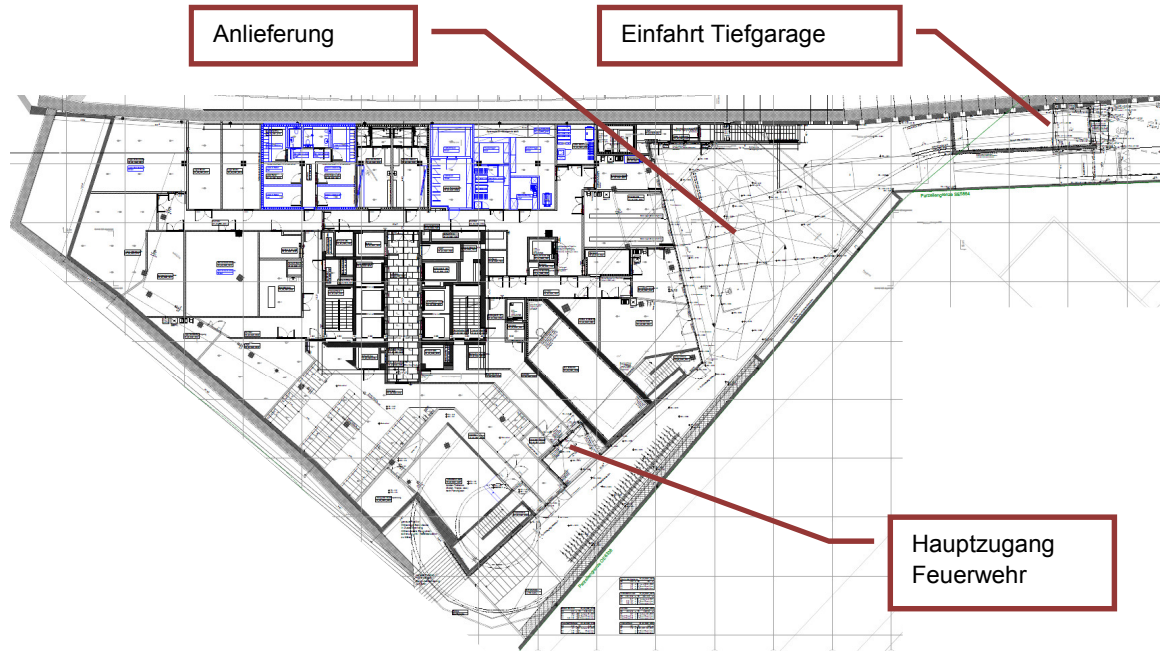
Grundriss 1. Untergeschoss mit Hauptzugang Feuerwehr, Nebenräumen und Anlieferungsbereich
